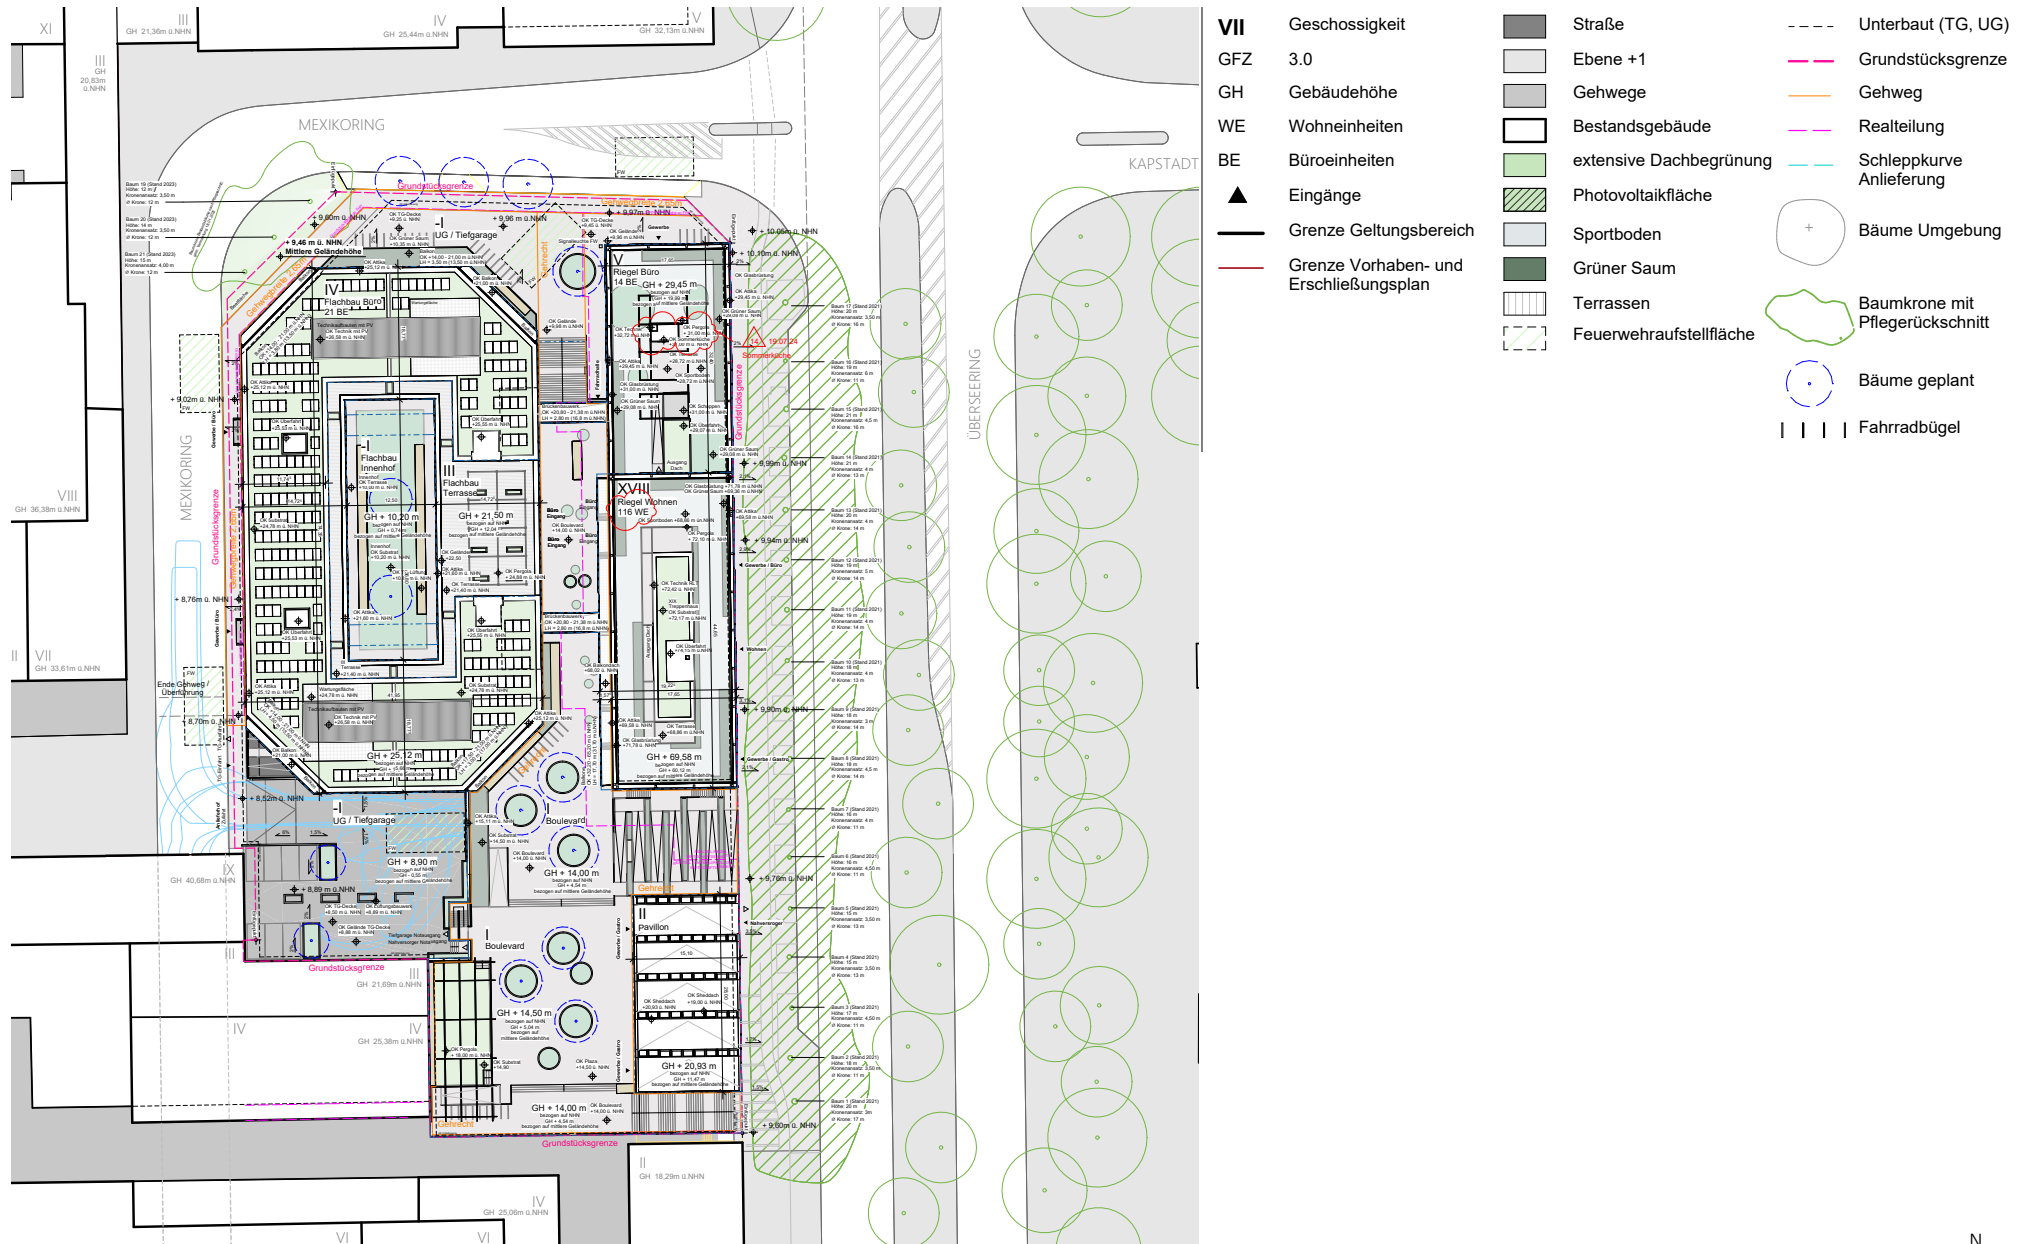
Ausschnitt Lageplan/ Funktionsplan. Blrm Architekt\*innen GmbH, Stand 19.07.2024.
